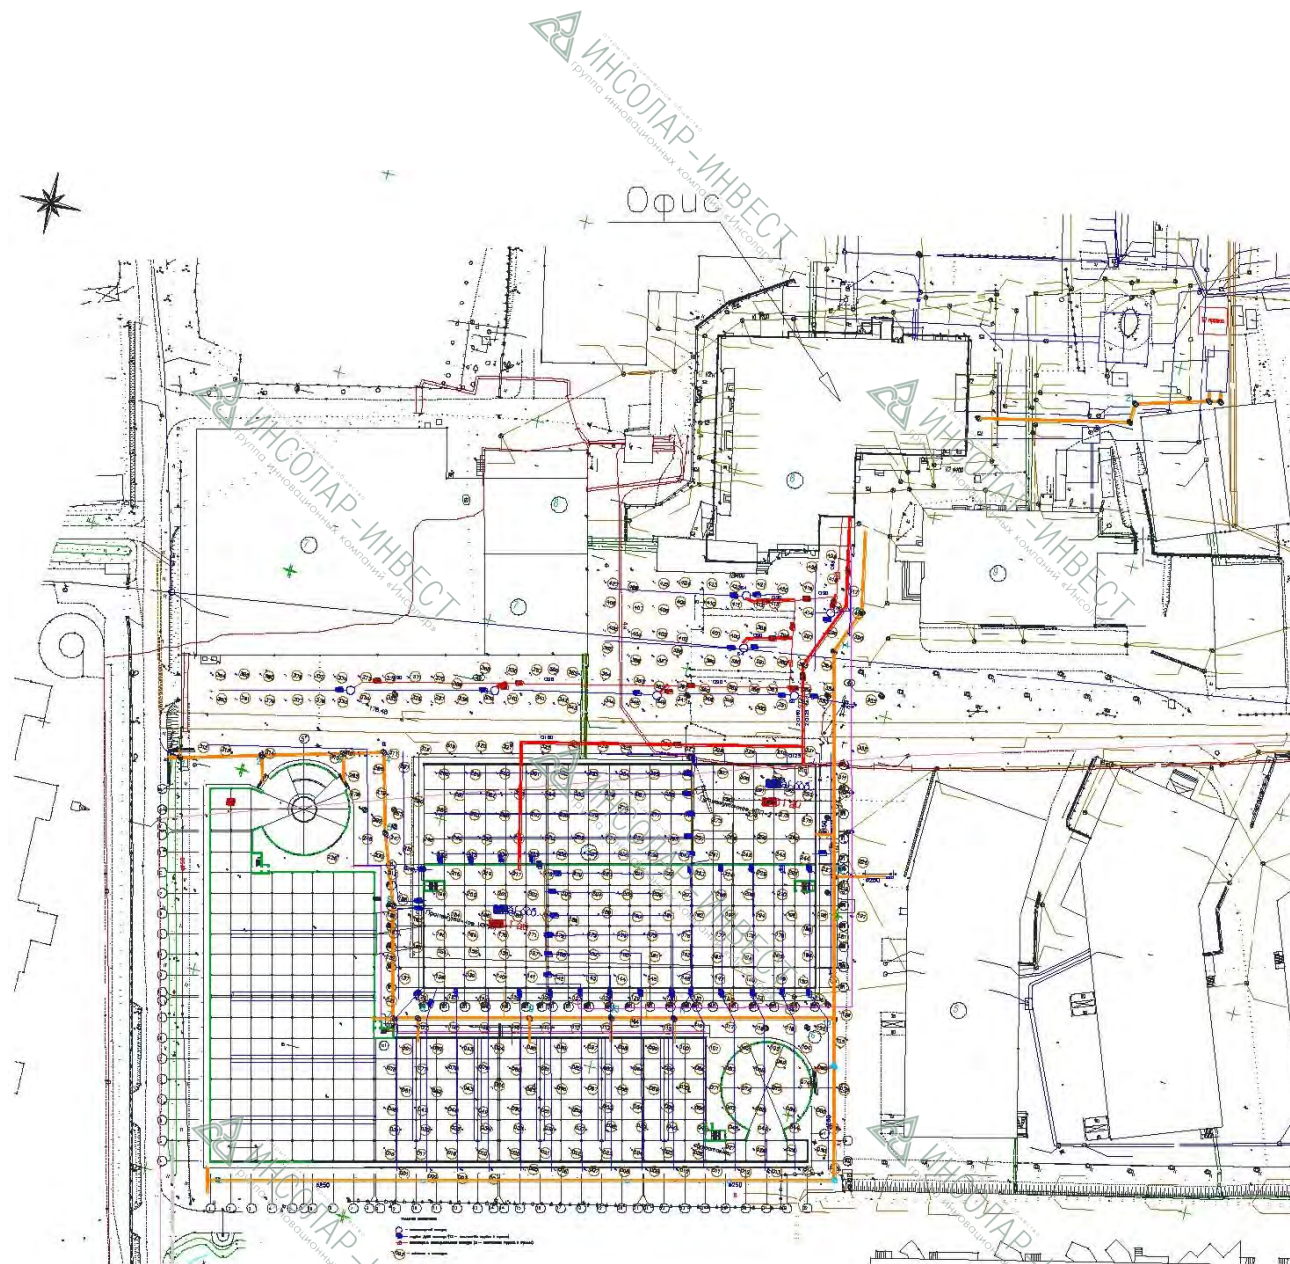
План размещения грунтовых теплообменников на площадке строительства.
